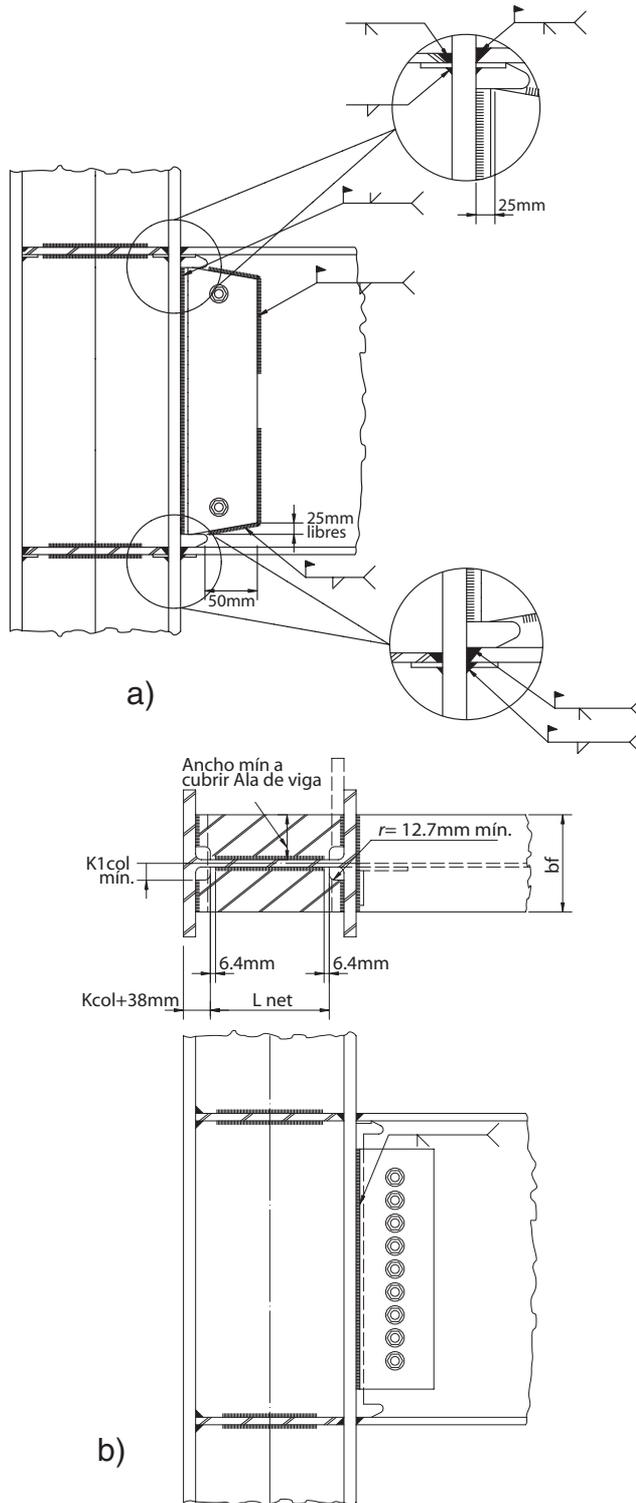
a, b. Uniones viga-columna precalificadas, ref.8.
